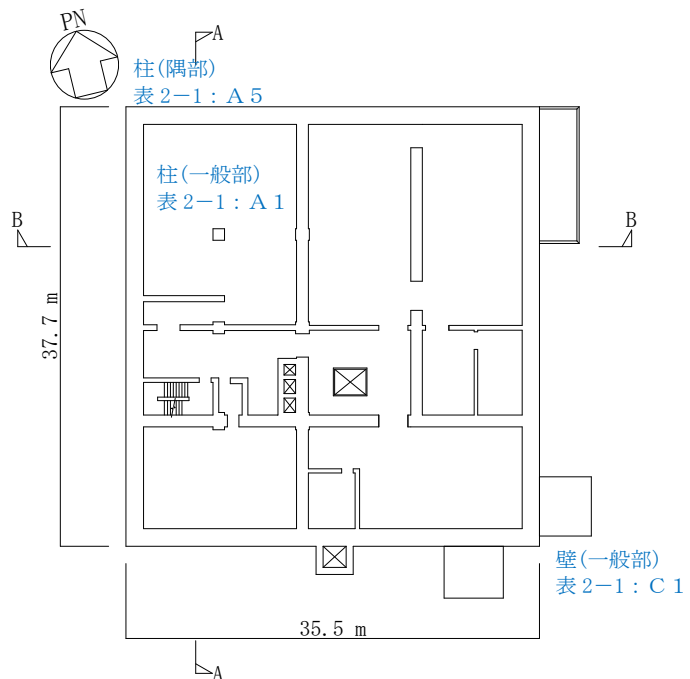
緊急時対策所建屋の概略平面図 (EL. 37.0 m)
